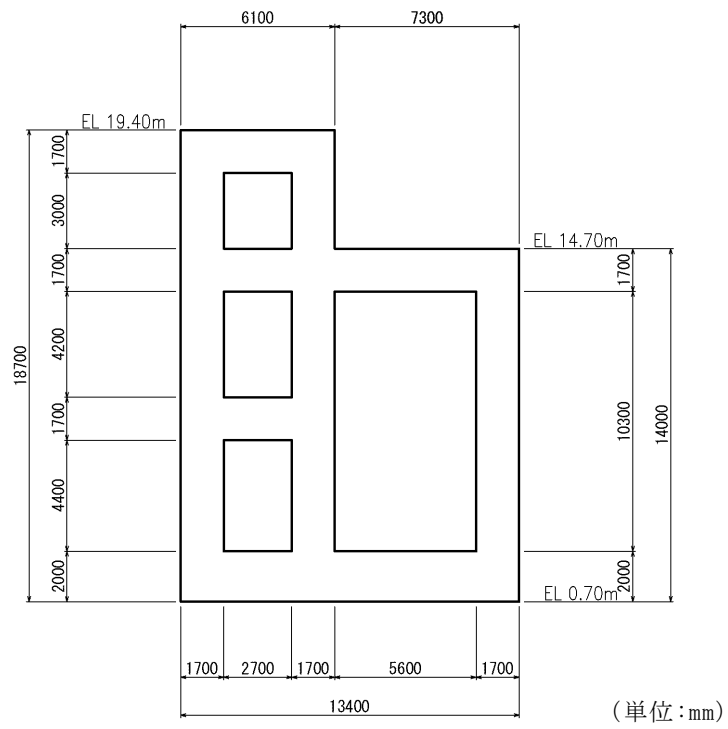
第 1 ベントフィルタ格納槽 断面図 (A-A断面)
